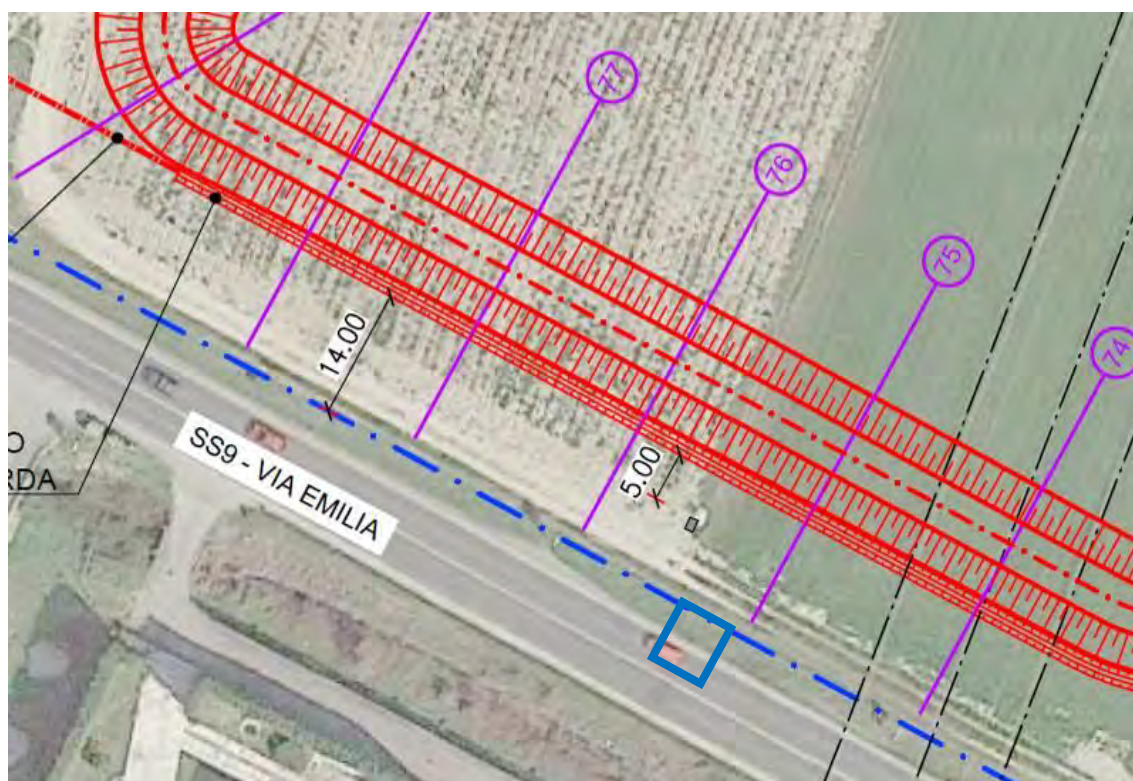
posizione quadro elettrico per alimentazione del sistema di irrigazione del vigneto presente in golena (stralcio planimetria di progetto).
